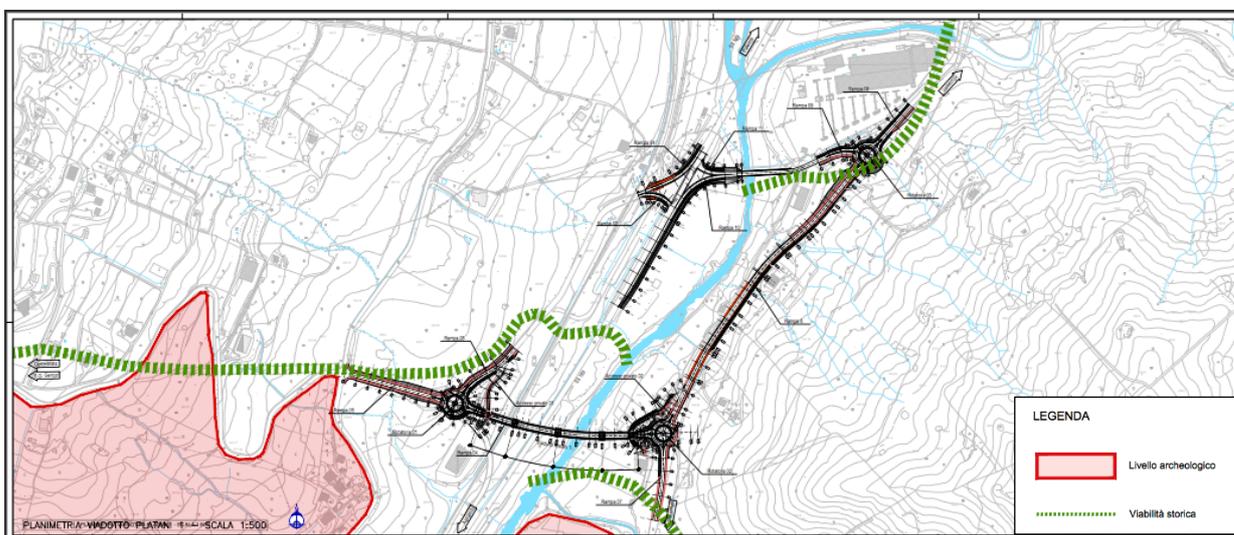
Planimetria dell'opera in progetto su carta archeologica
